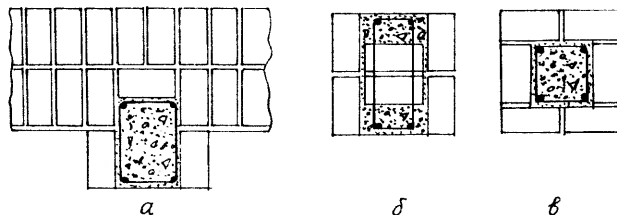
Схемы сечений комплексных элементов: а – одностороннее расположение железобетона; б – расположение железобетона в штрабе; в – расположение железобетона внутри кладки
